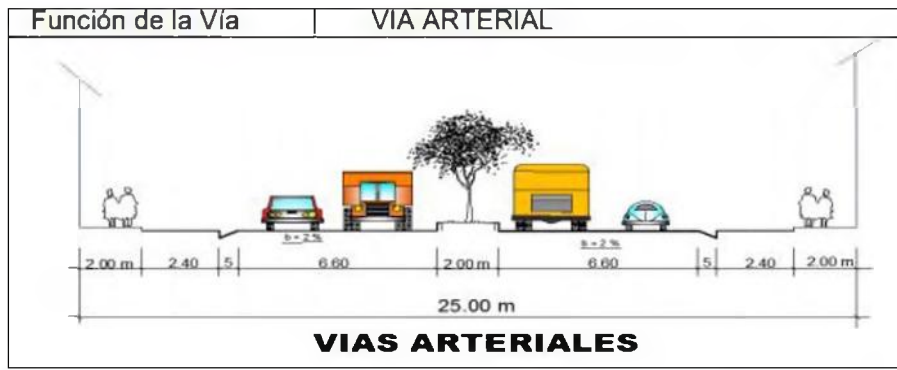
SECCION TIPICA VIA DE EVITAMIENTO
